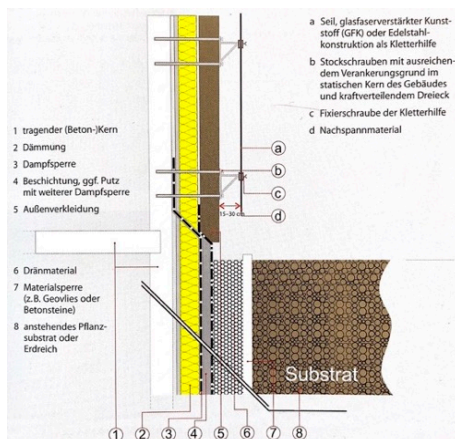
Baukonstruktive Illustration einer nachträglich montierten Fassadenbegrünung. [© Köhler et al. (Hrsg.), 2012]
